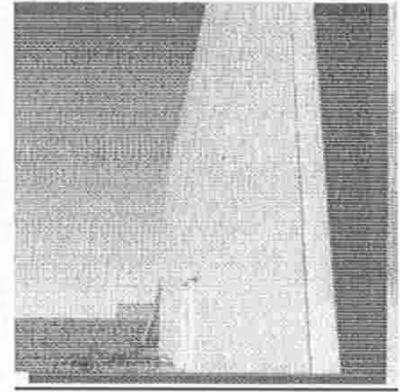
Muro a base de insul-panel, toma en perspectiva de una planta frigorífica (Fuente manual técnico de insul-panel, fanosa.)
